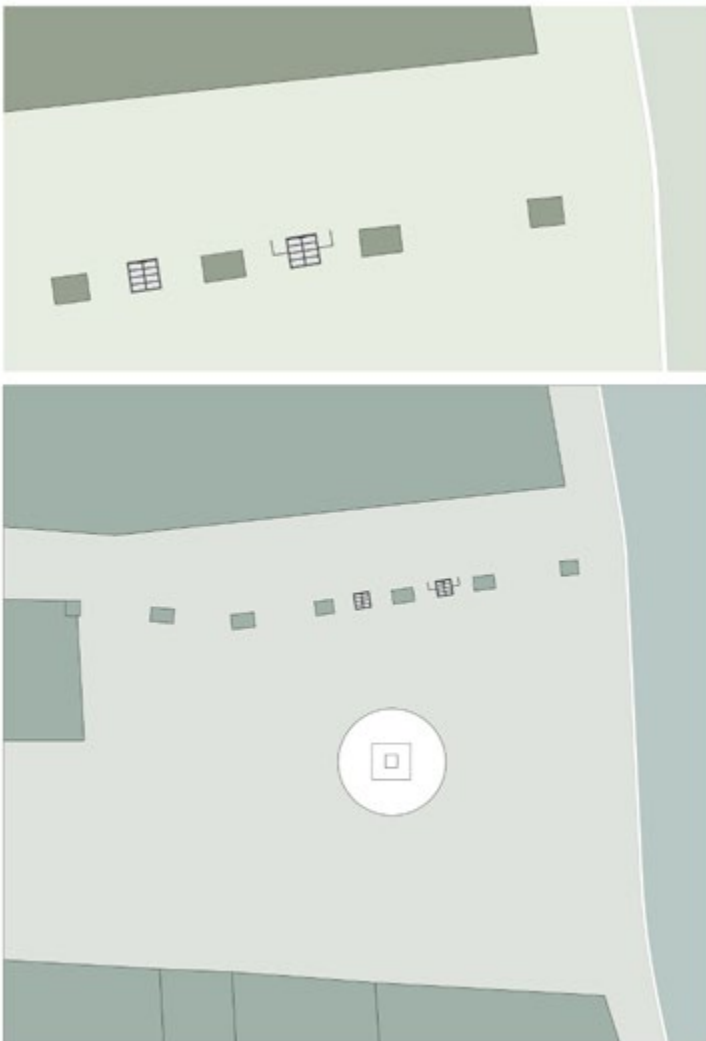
Levantamento da Planta com Proposta de Implantação do Equipamento.
